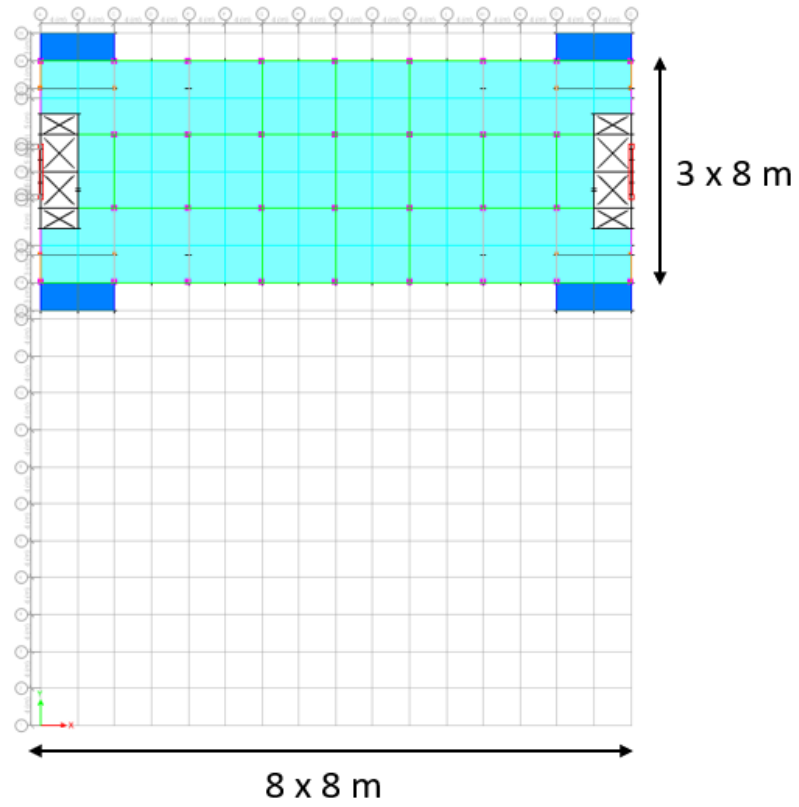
Denah Tipikal Lantai 3 dan 4 Untuk Model 1, 2, 3, dan 4
